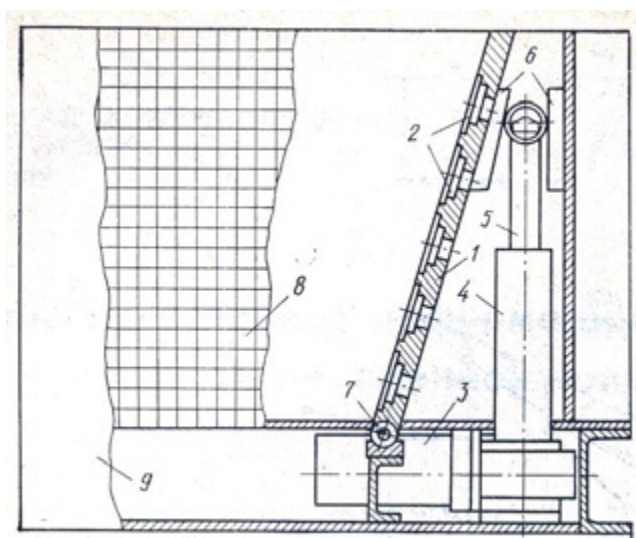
Схема экспериментальной кассеты с подпорной стенкой:
